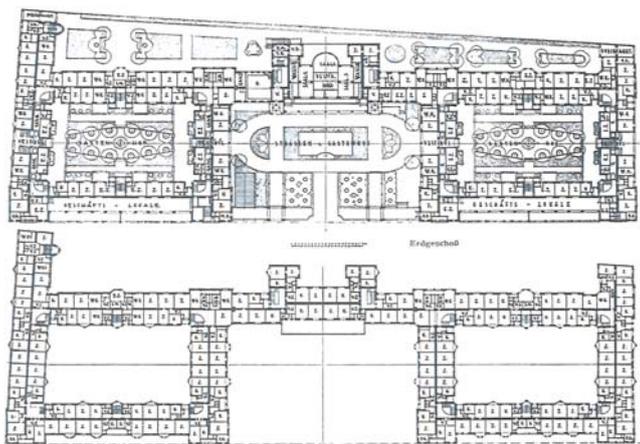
Grundriss Reumann-Hof EG oben, RG unten
